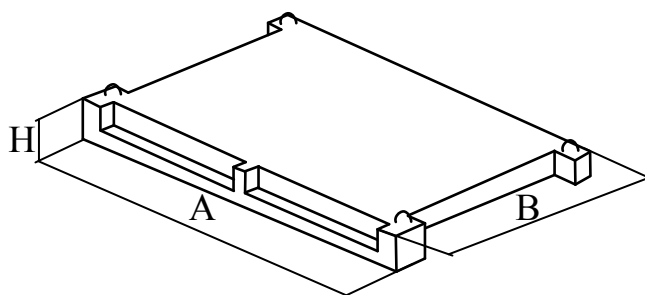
Лестничная площадка ЛПР 25–16к
